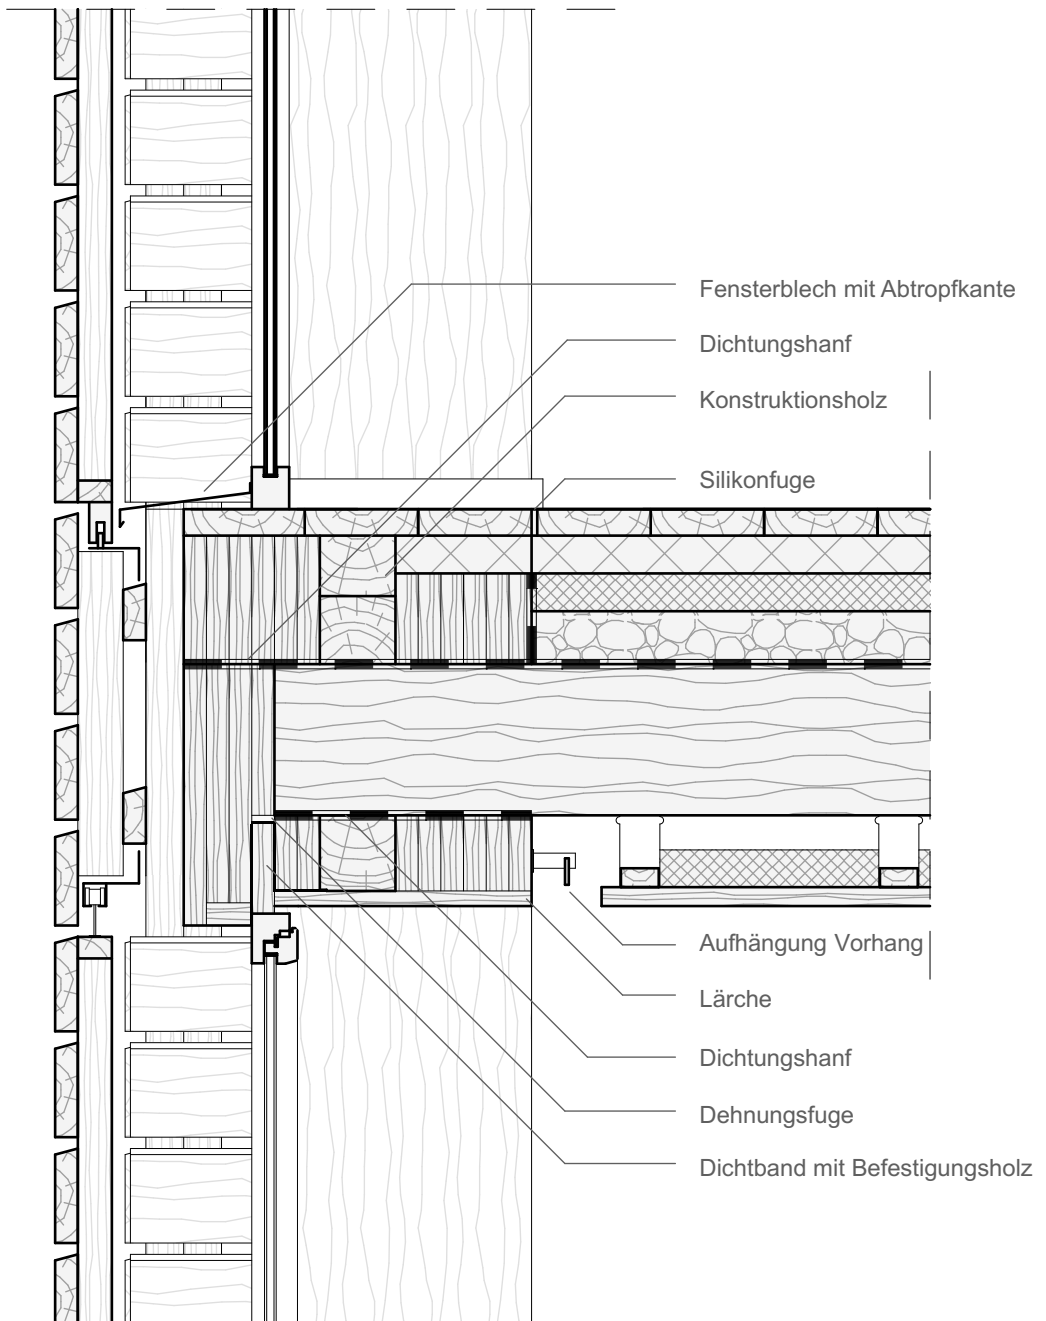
Fensteranschluss - Detail M 1:10
